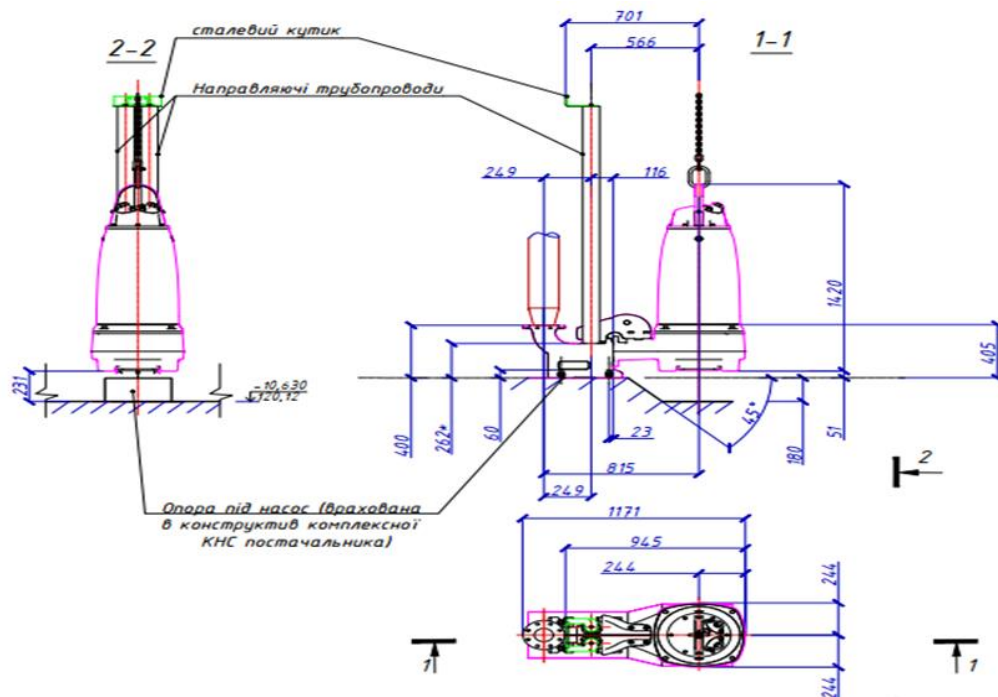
Габаритні розміри насосного агрегату Flygt NP 3202 SH3~273.
